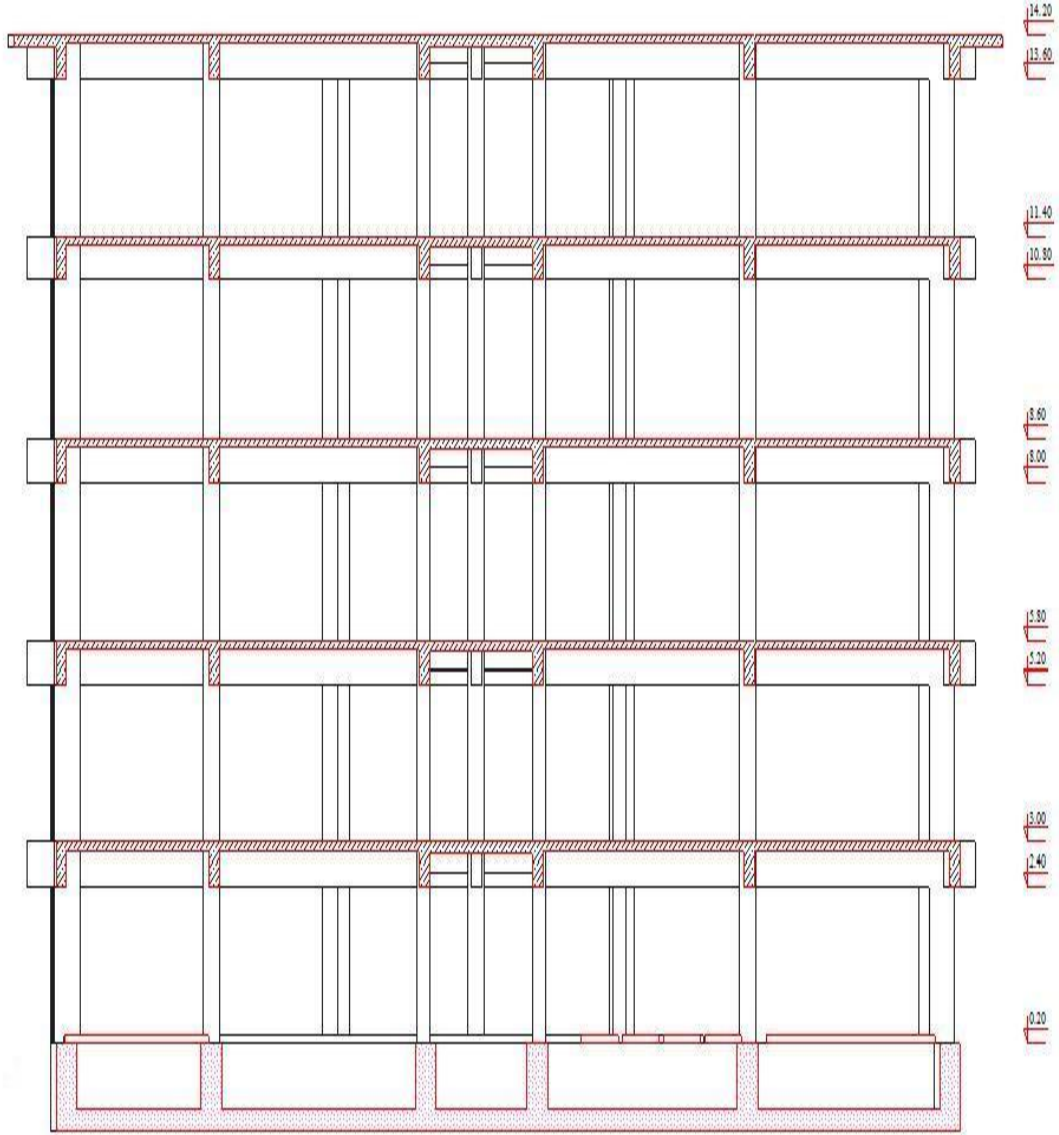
Tip 9 Uygulamasında Bina Planı
